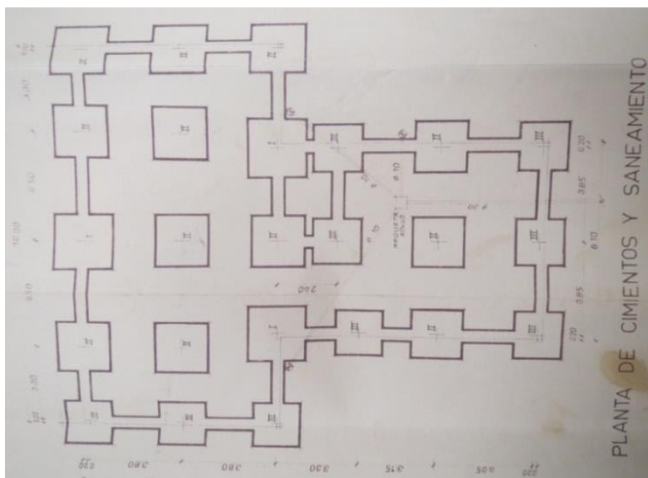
Proyecto de edificación bloque Fase B. Plano cimentación. Año 1962.
